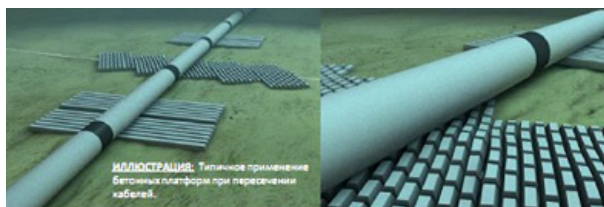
Пересечение силового кабеля с устройством бетонных опор
